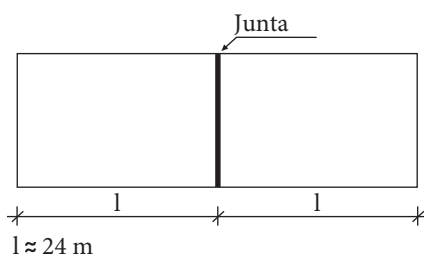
Detalhe de uma junta de dilatação em planta com recorte (a junta pode ser feita apenas na laje do *hall* de elevadores) ou planta contínua (a junta deve se estender por toda a largura do prédio e também nas paredes).
